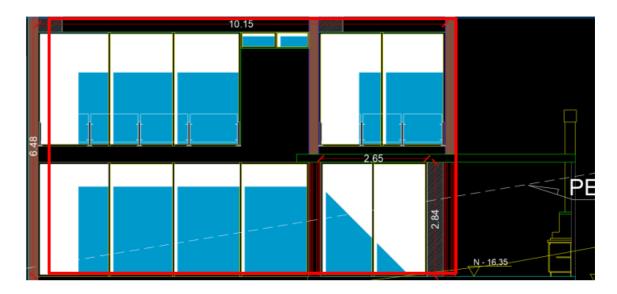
Dimensiones de la Unidad 5 y 6 Fachada Sur
